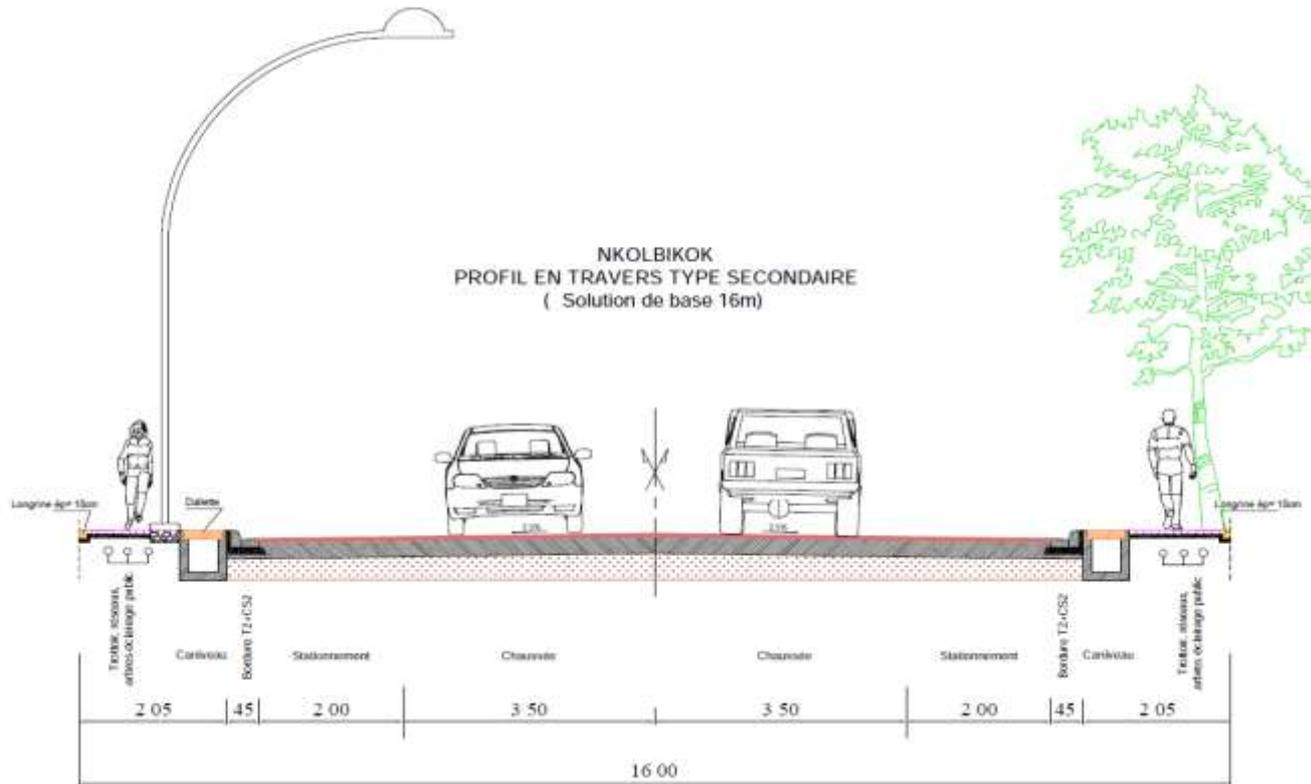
Profil en Travers Type de la Voie Secondaire Projetée (Solution de base)
